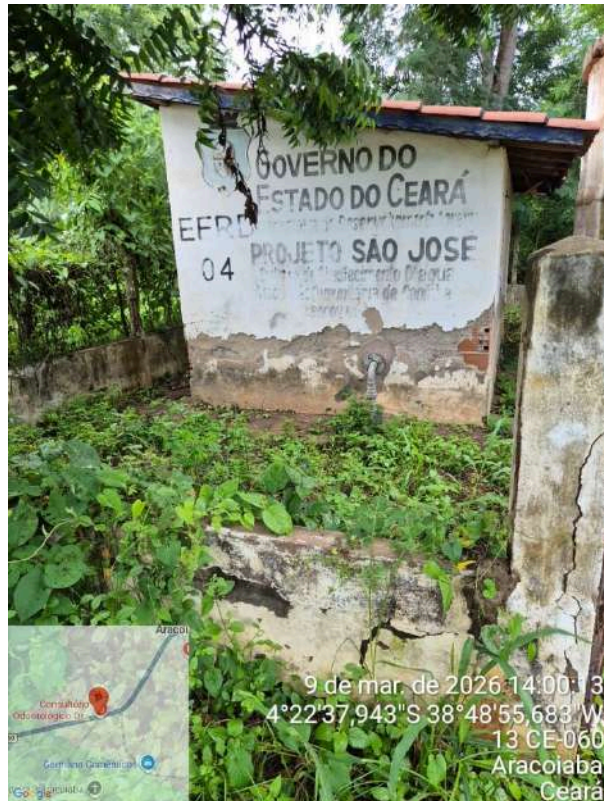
EERD-04: cerca e muro com fissuras e rachaduras, parede com estrutura deteriorada, identificação desgastada.
